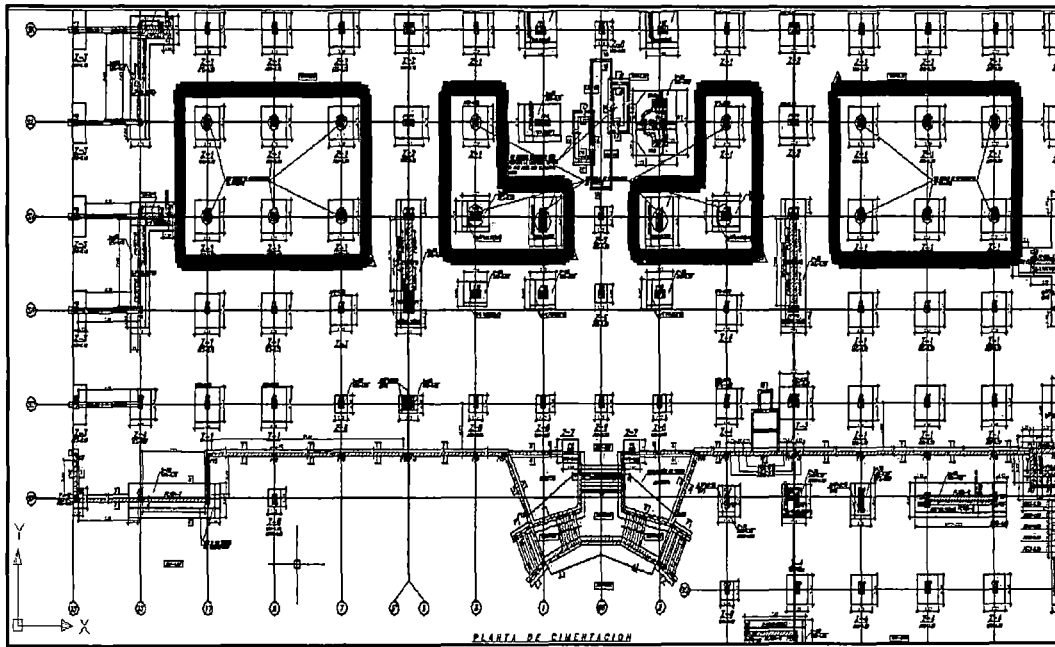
ESQUEMA GENERAL DE COLUMNAS REFORZADAS
